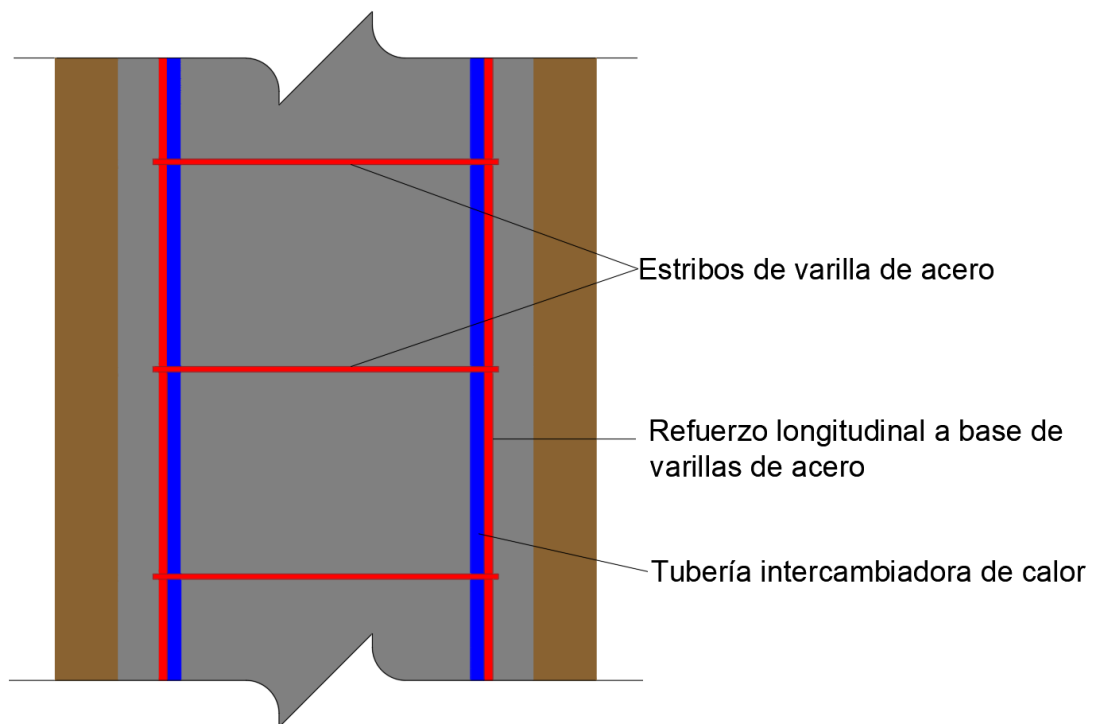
Detalle de la sección longitudinal de la pila de energía
